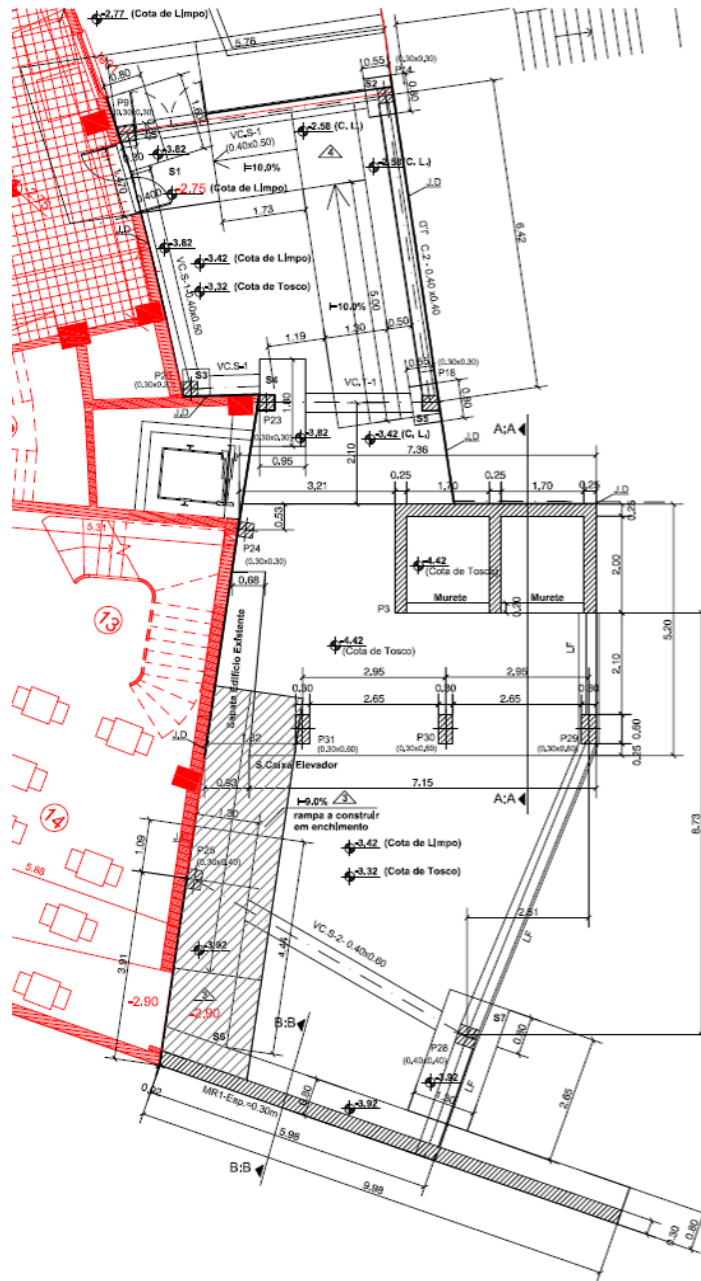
Planta das fundações e piso – 1 - preparação dos trabalhos [AVicêncio A, 2017]
